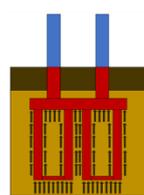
Moderne Flach- und Tiefgründungen aus Stahlbeton
